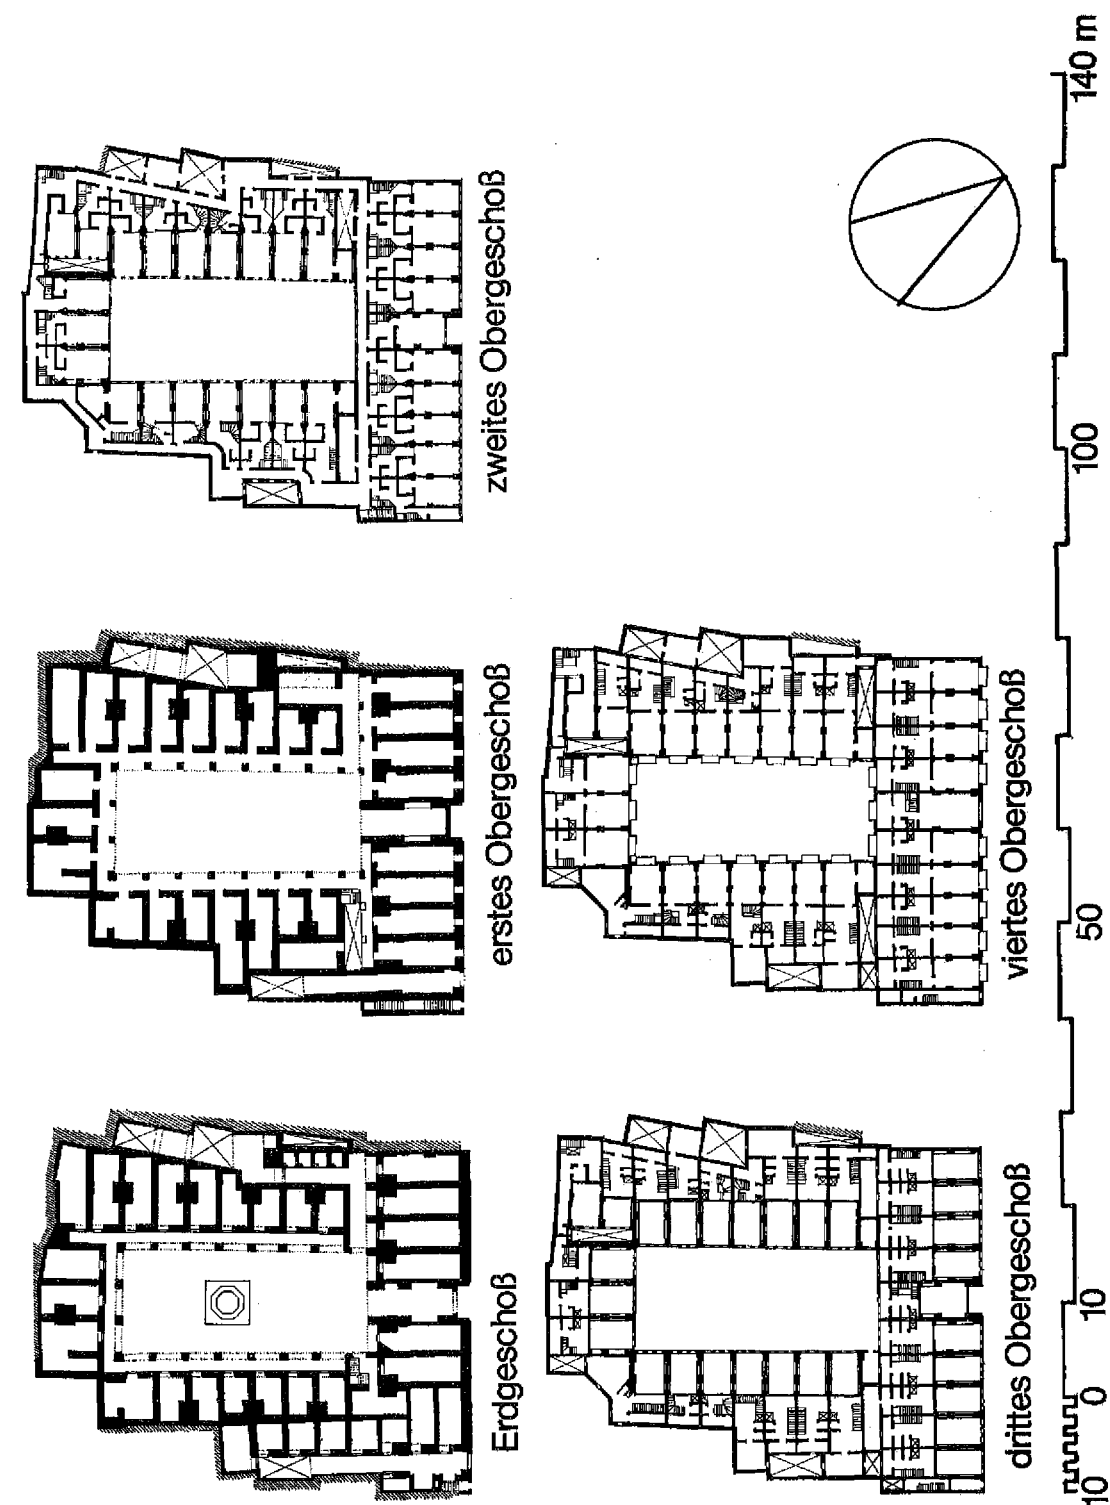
Kairo, Wakālat al-Quṭn, Grundrisse der fünf Geschosse
